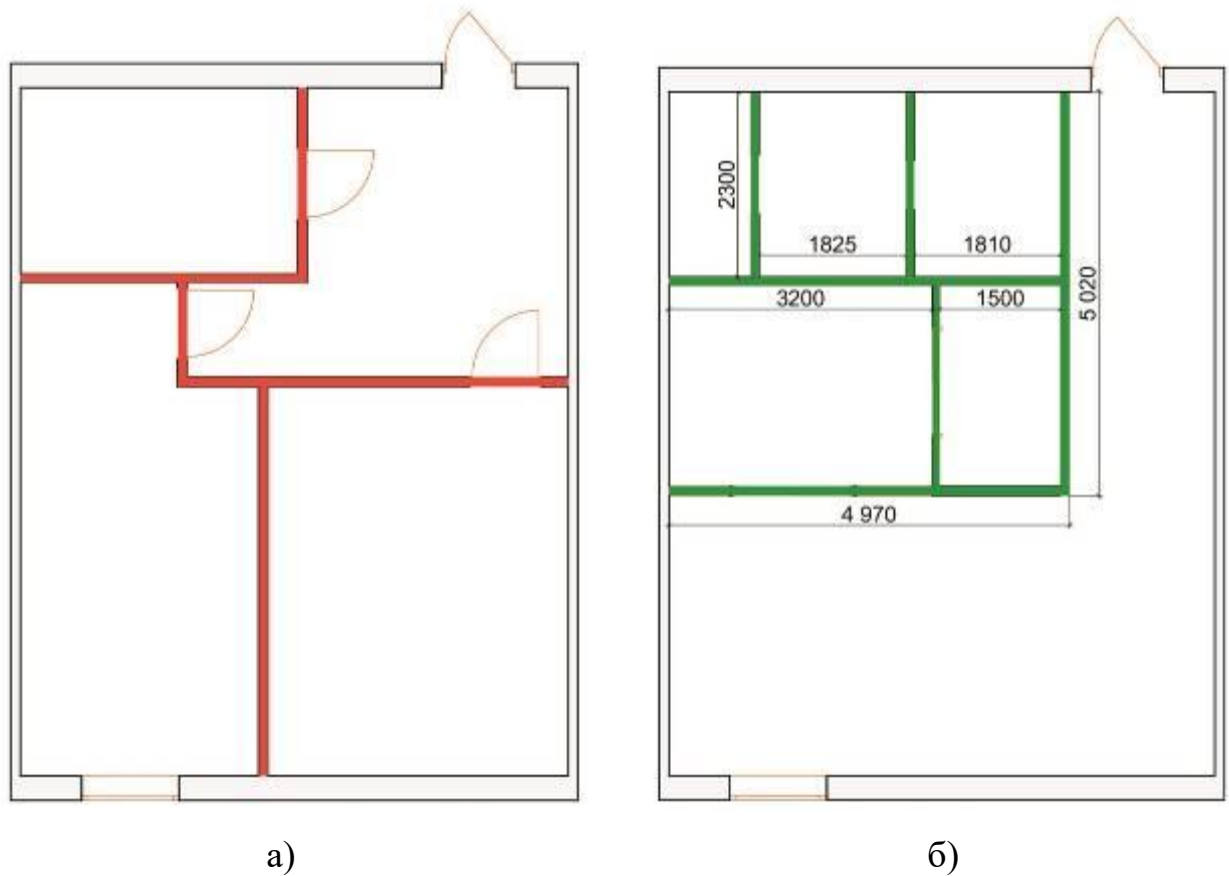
План а) демонтажу стін та б) монтажу стін
